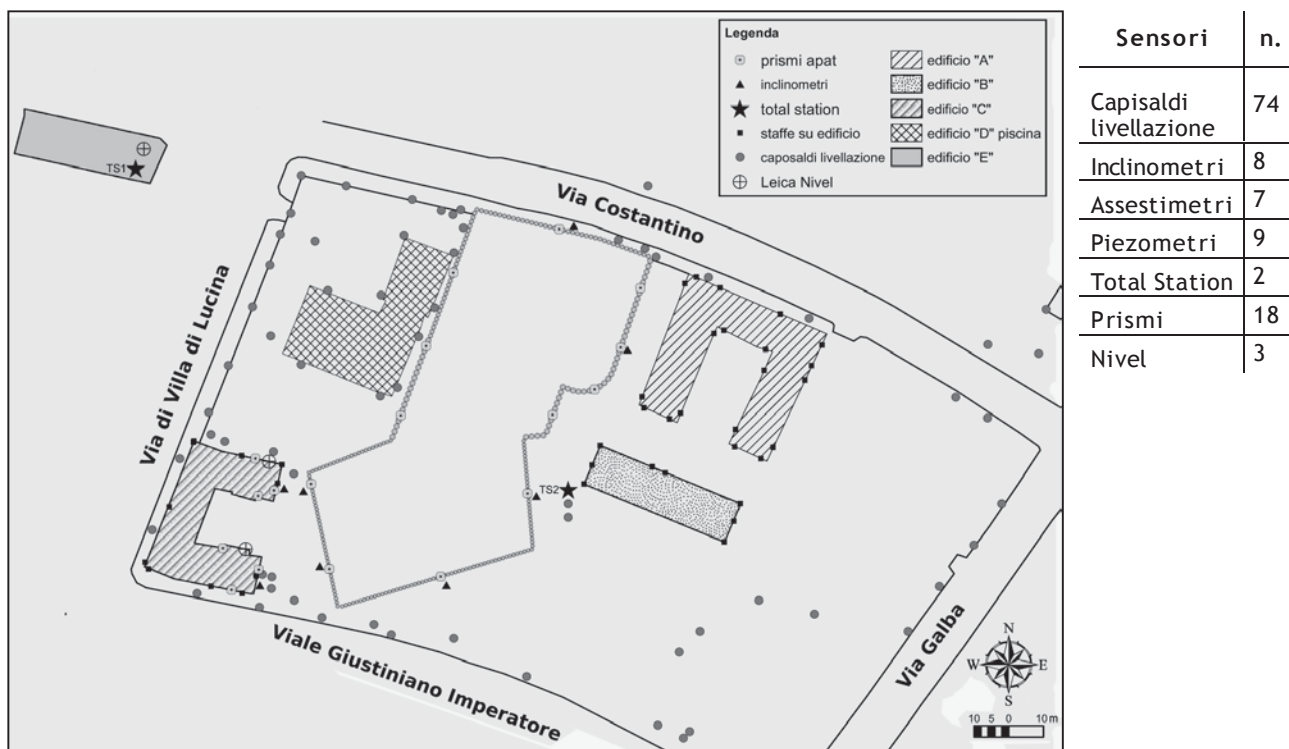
planimetria dell'area coperta dalla rete di monitoraggio
